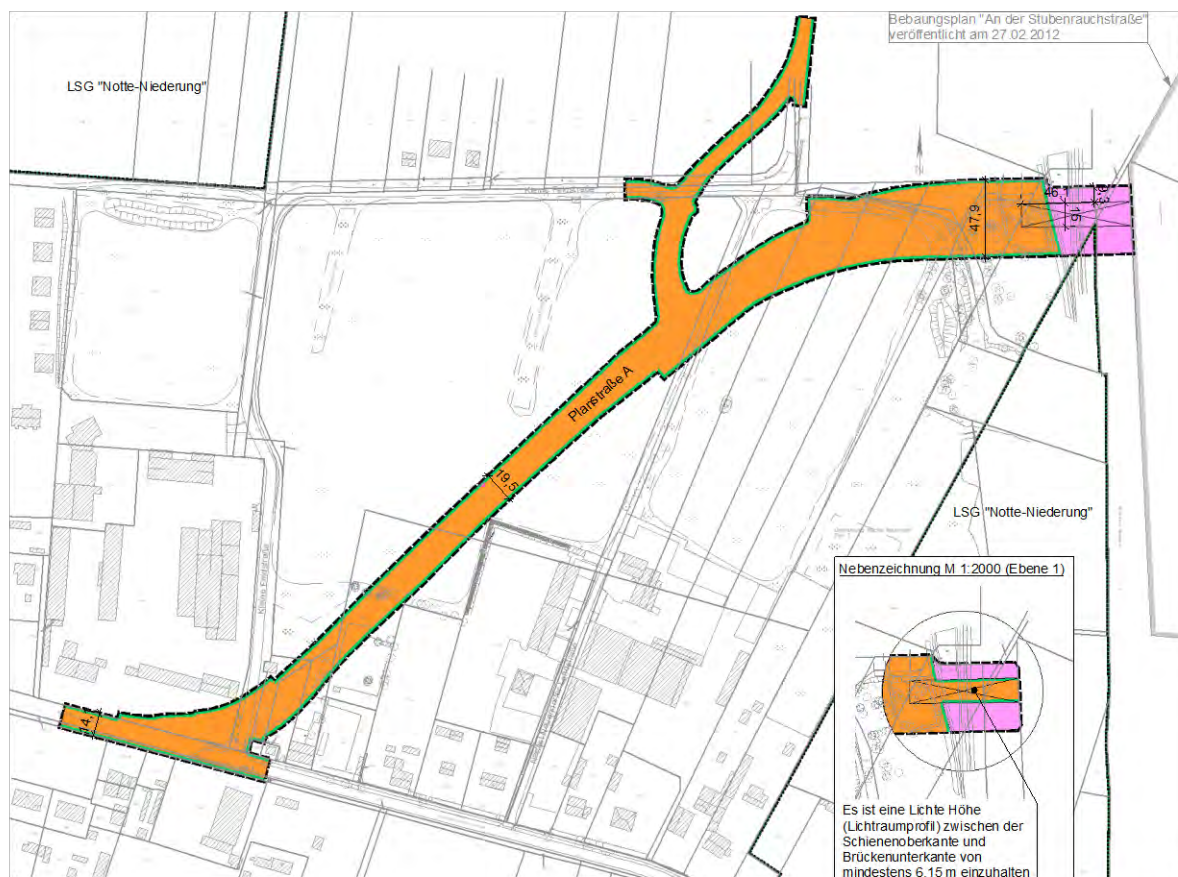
Planzeichnung des Bebauungsplanes (skaliert)
